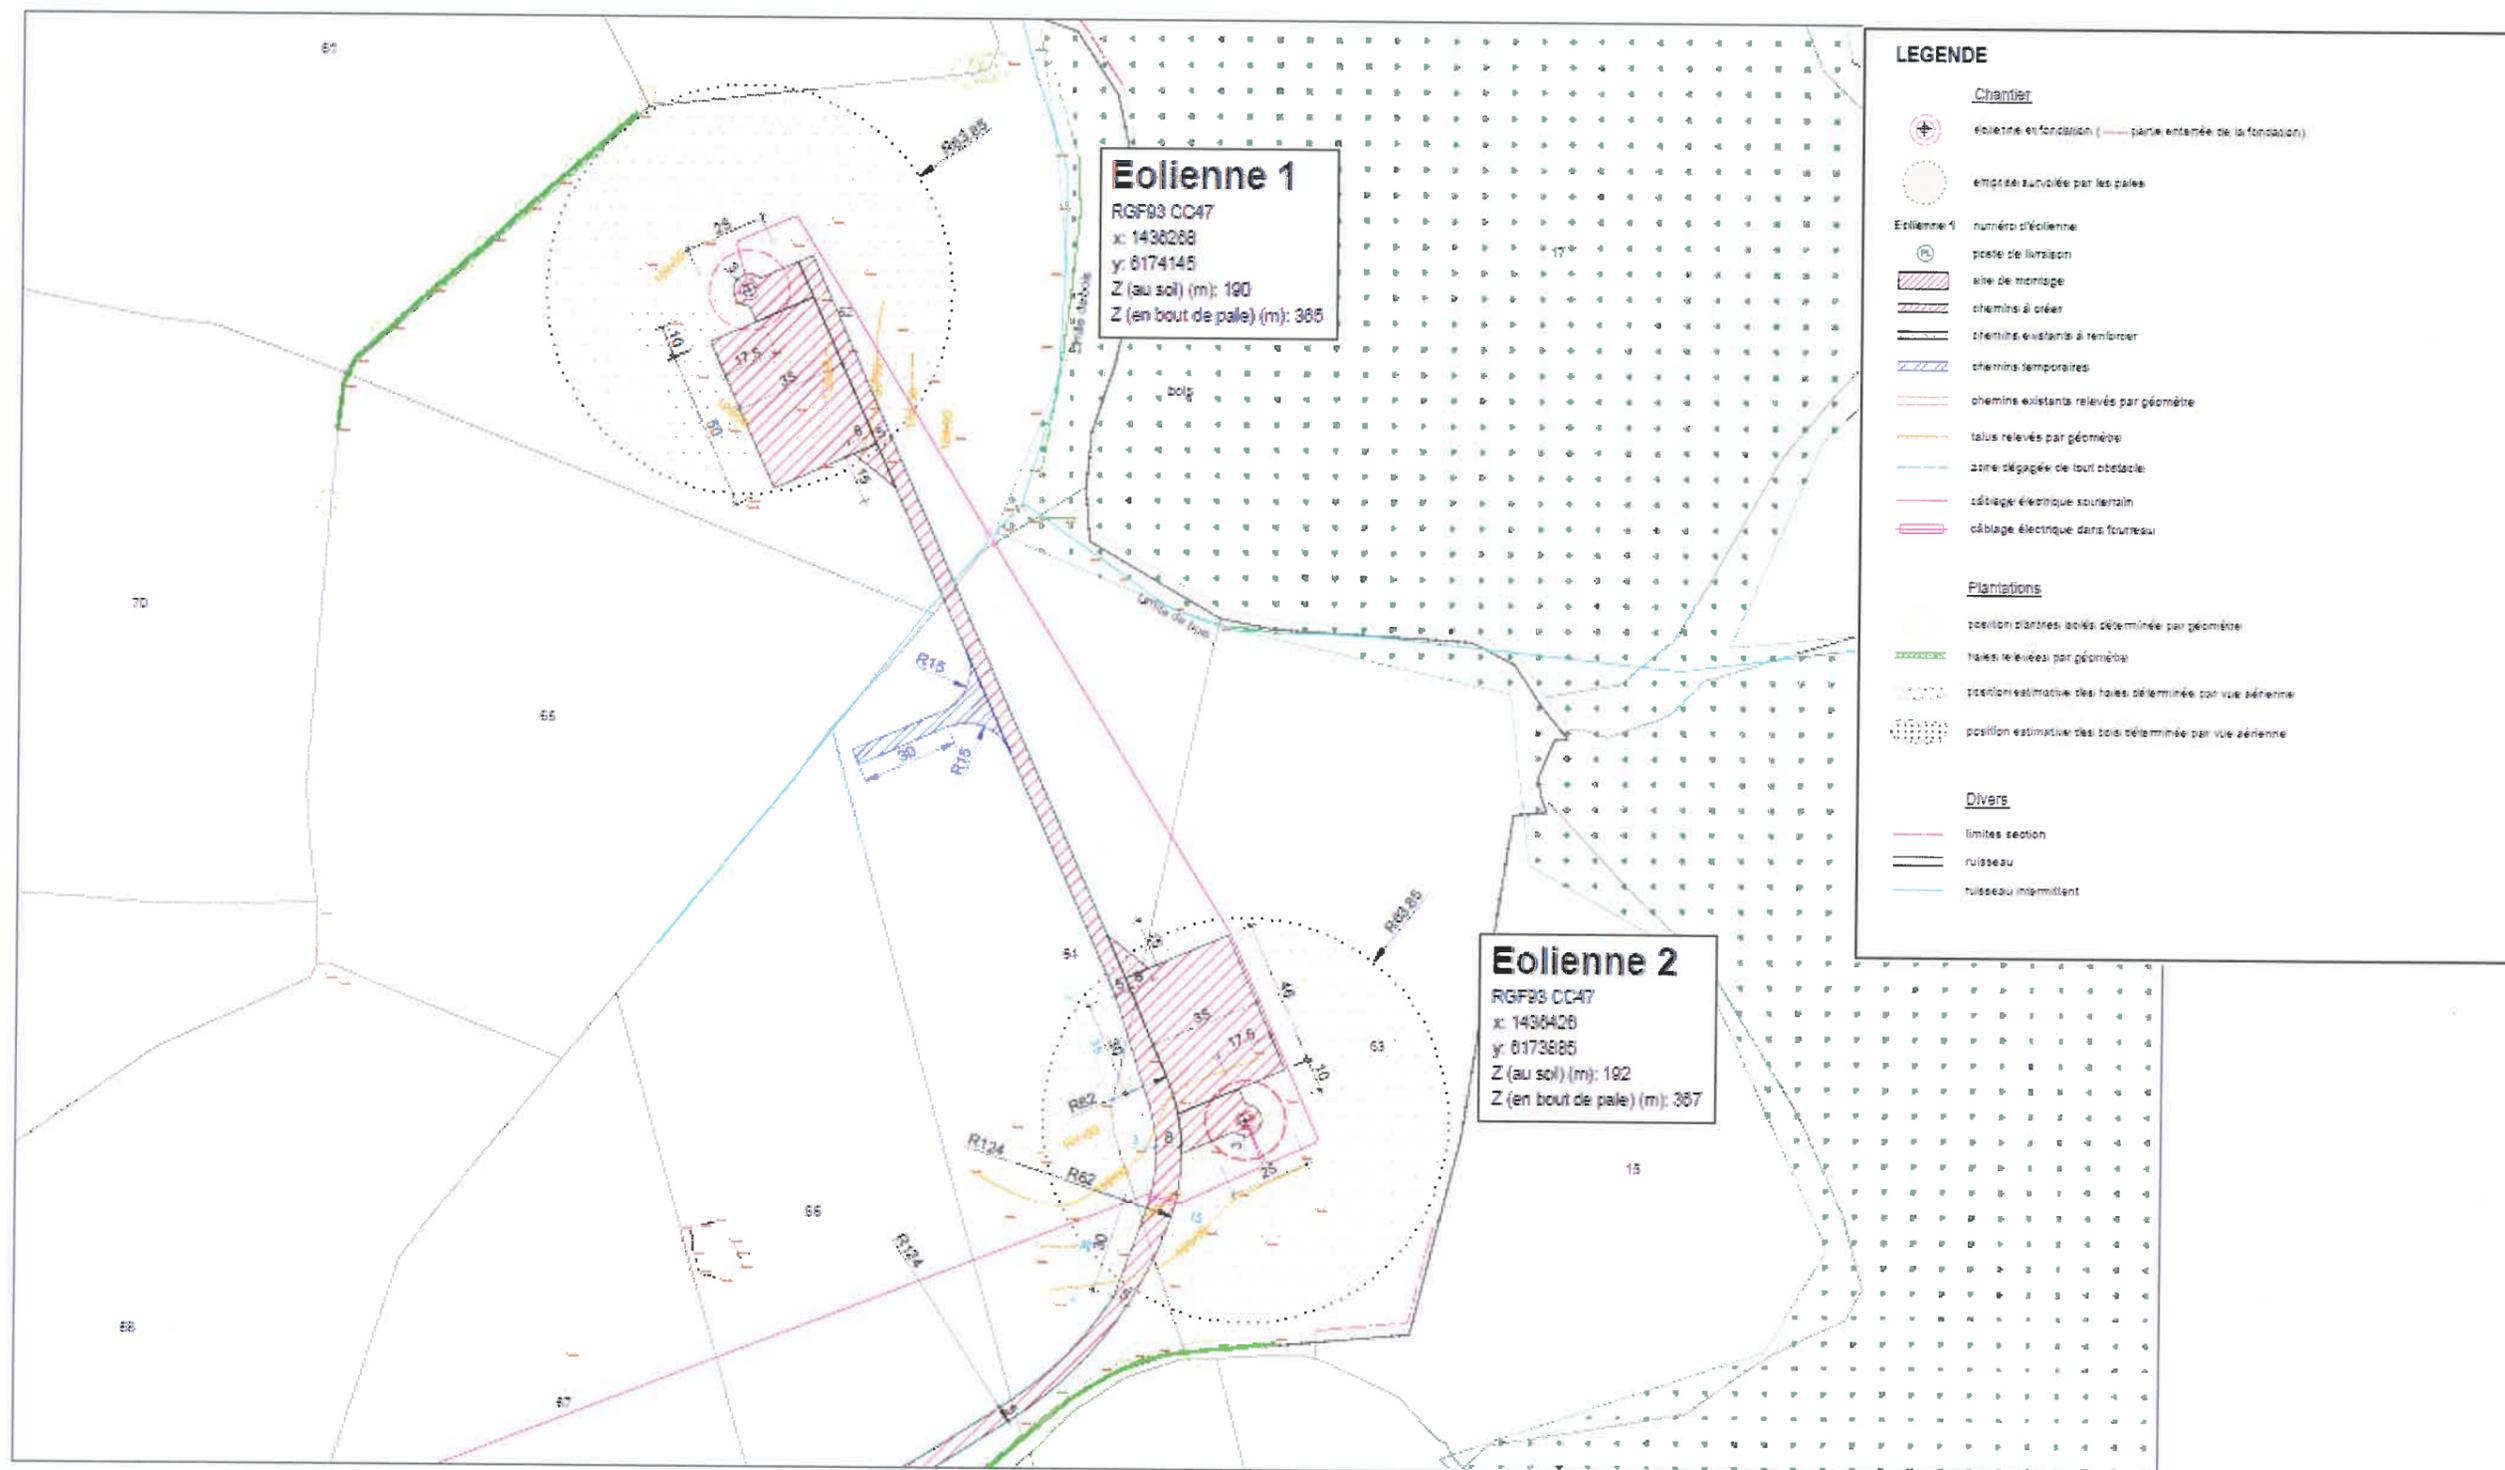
Plan de masse – Zoom sur les éoliennes E1 et E2
